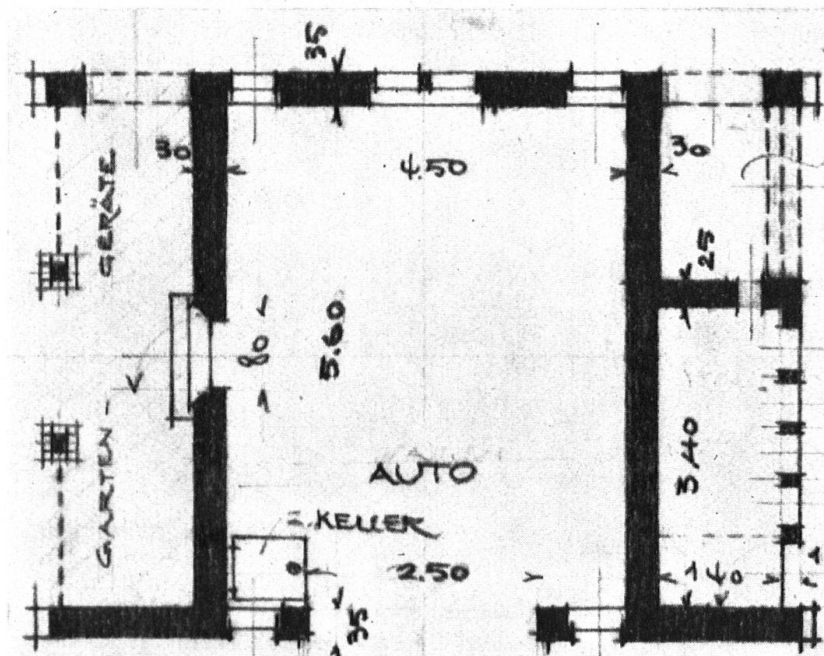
Grundriss zur Garage Abb. 15 und 13. Mitte: Raum für zwei Autos, links Gerätekammer, rechts Hühnerstall. — Fig. 14. Plan du garage fig. 13 et 15. Au milieu; espace pour deux machines; à gauche: hangar aux outils; à droite: poulailler.
